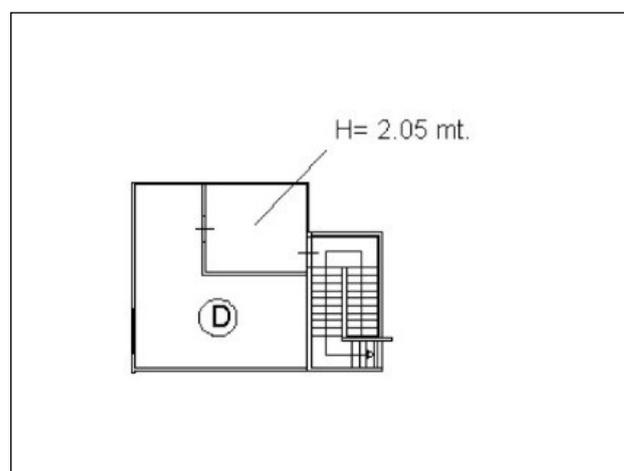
Stralcio della planimetria catastale del 06/05/2008. Piano ammezzato.
